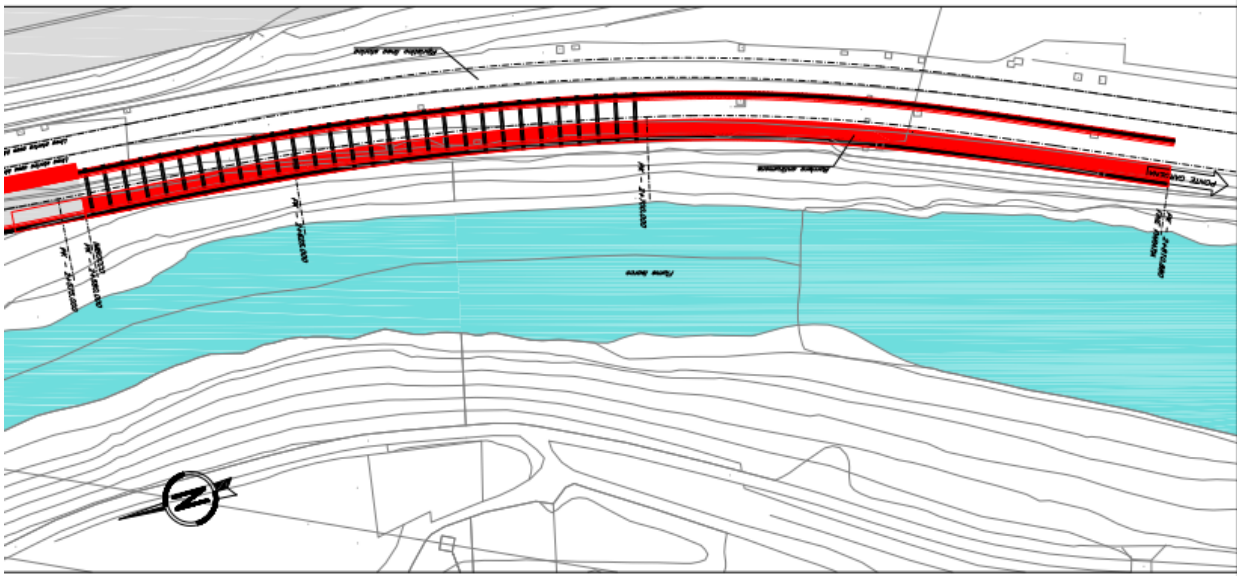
Progetto Definitivo - Planimetria dell'imbocco (Parte 1/2)
